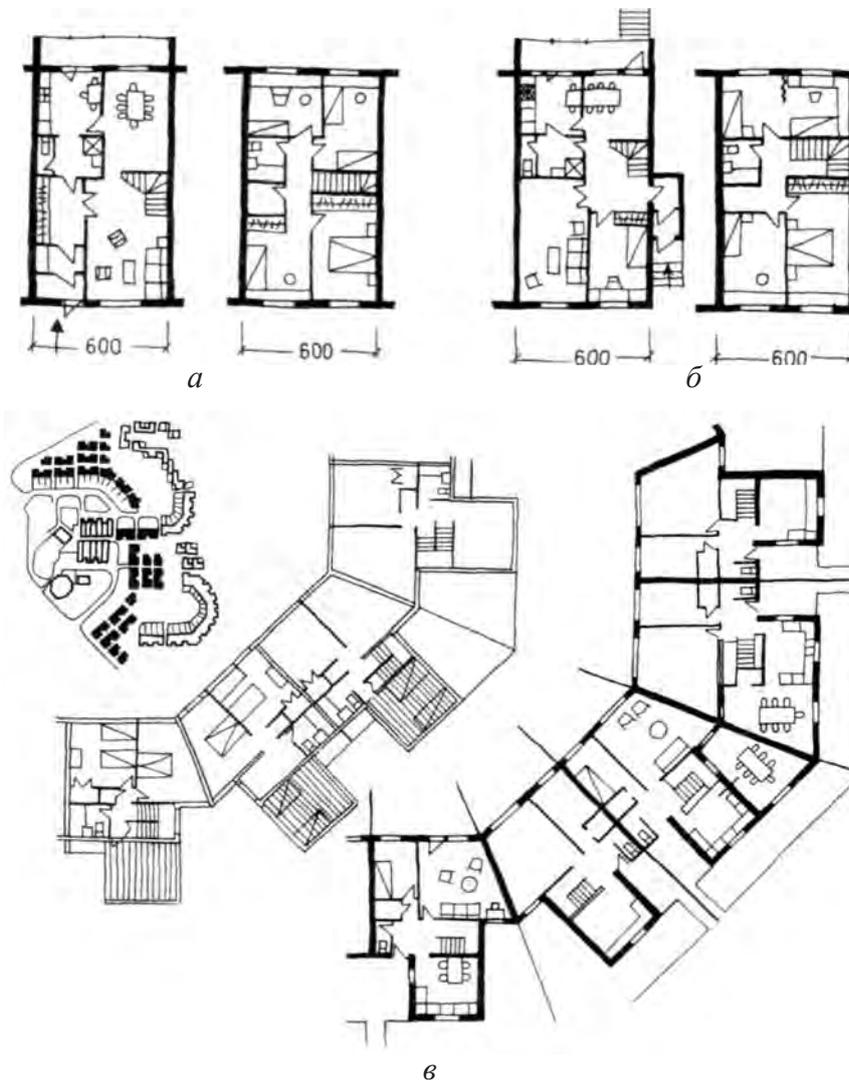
Поселок в пригороде Лондона. Общий вид. Типы блоков: *а* — рядовой; *б* — торцевой; *в* — поворотный, планы первого и второго этажей, генеральный план
